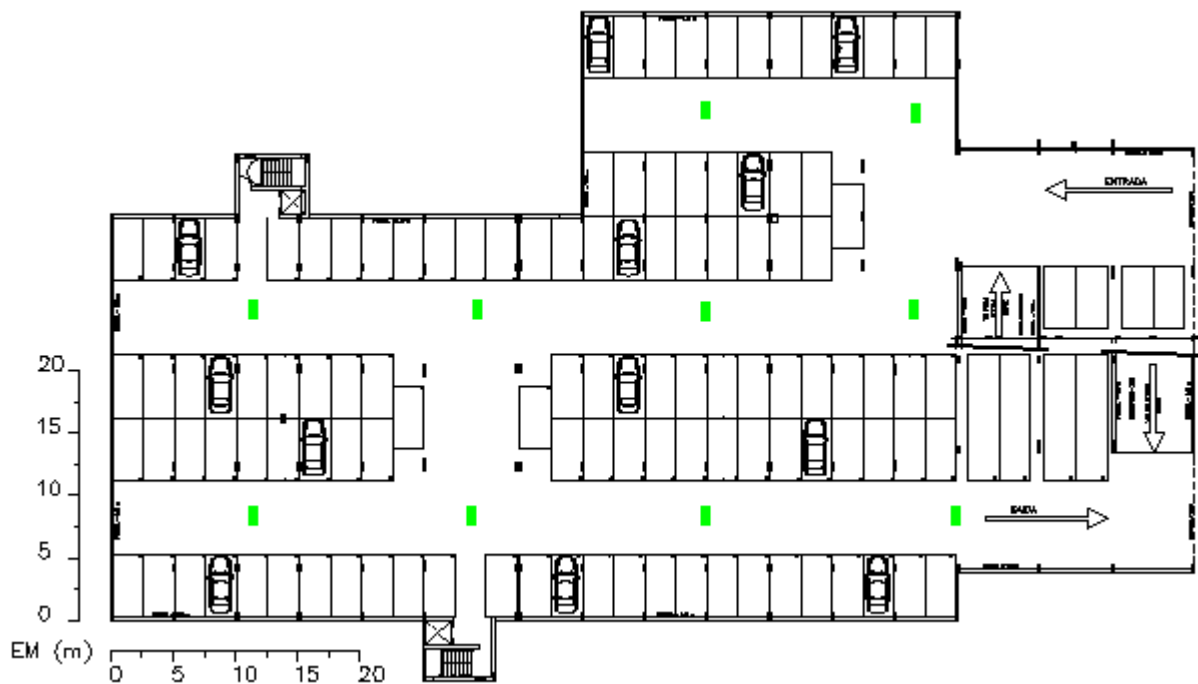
Localização da Sinalização das Saídas no Pavimento Térreo
